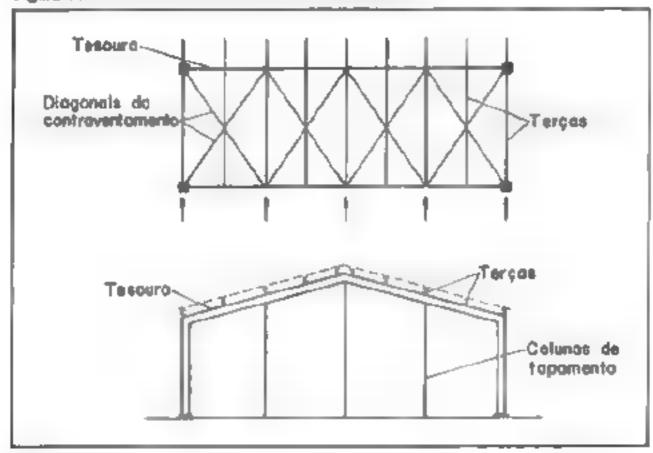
TRELIÇA DE CONTRAVENTAMENTO
